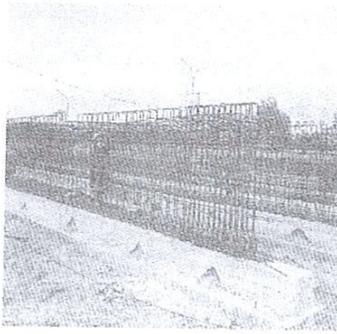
ferrailage de poutre. Photo 1.6: coffrage de poutre. Photo 1.7: décoffrage de poutre
